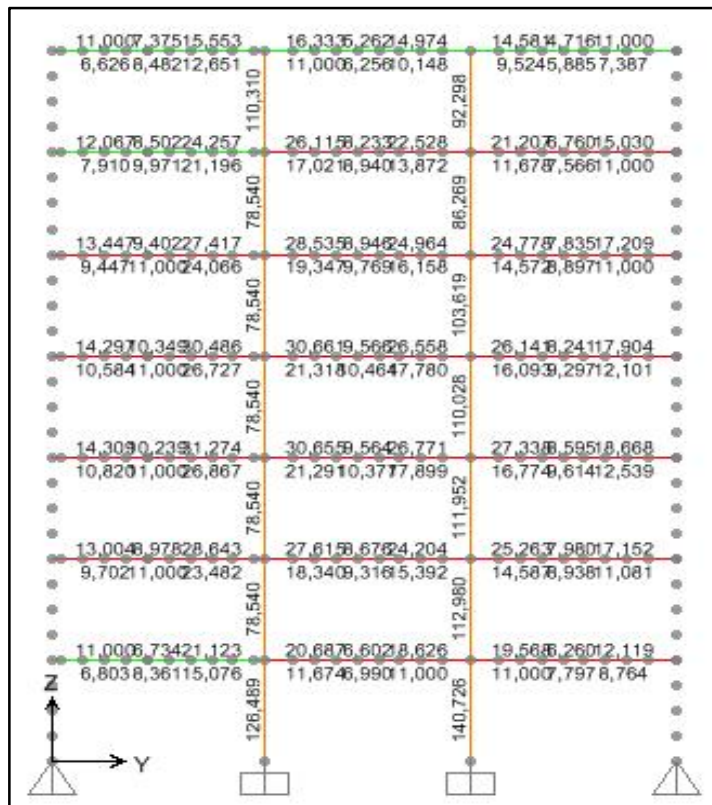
Acero en vigas pórtico 12, Hall Central
